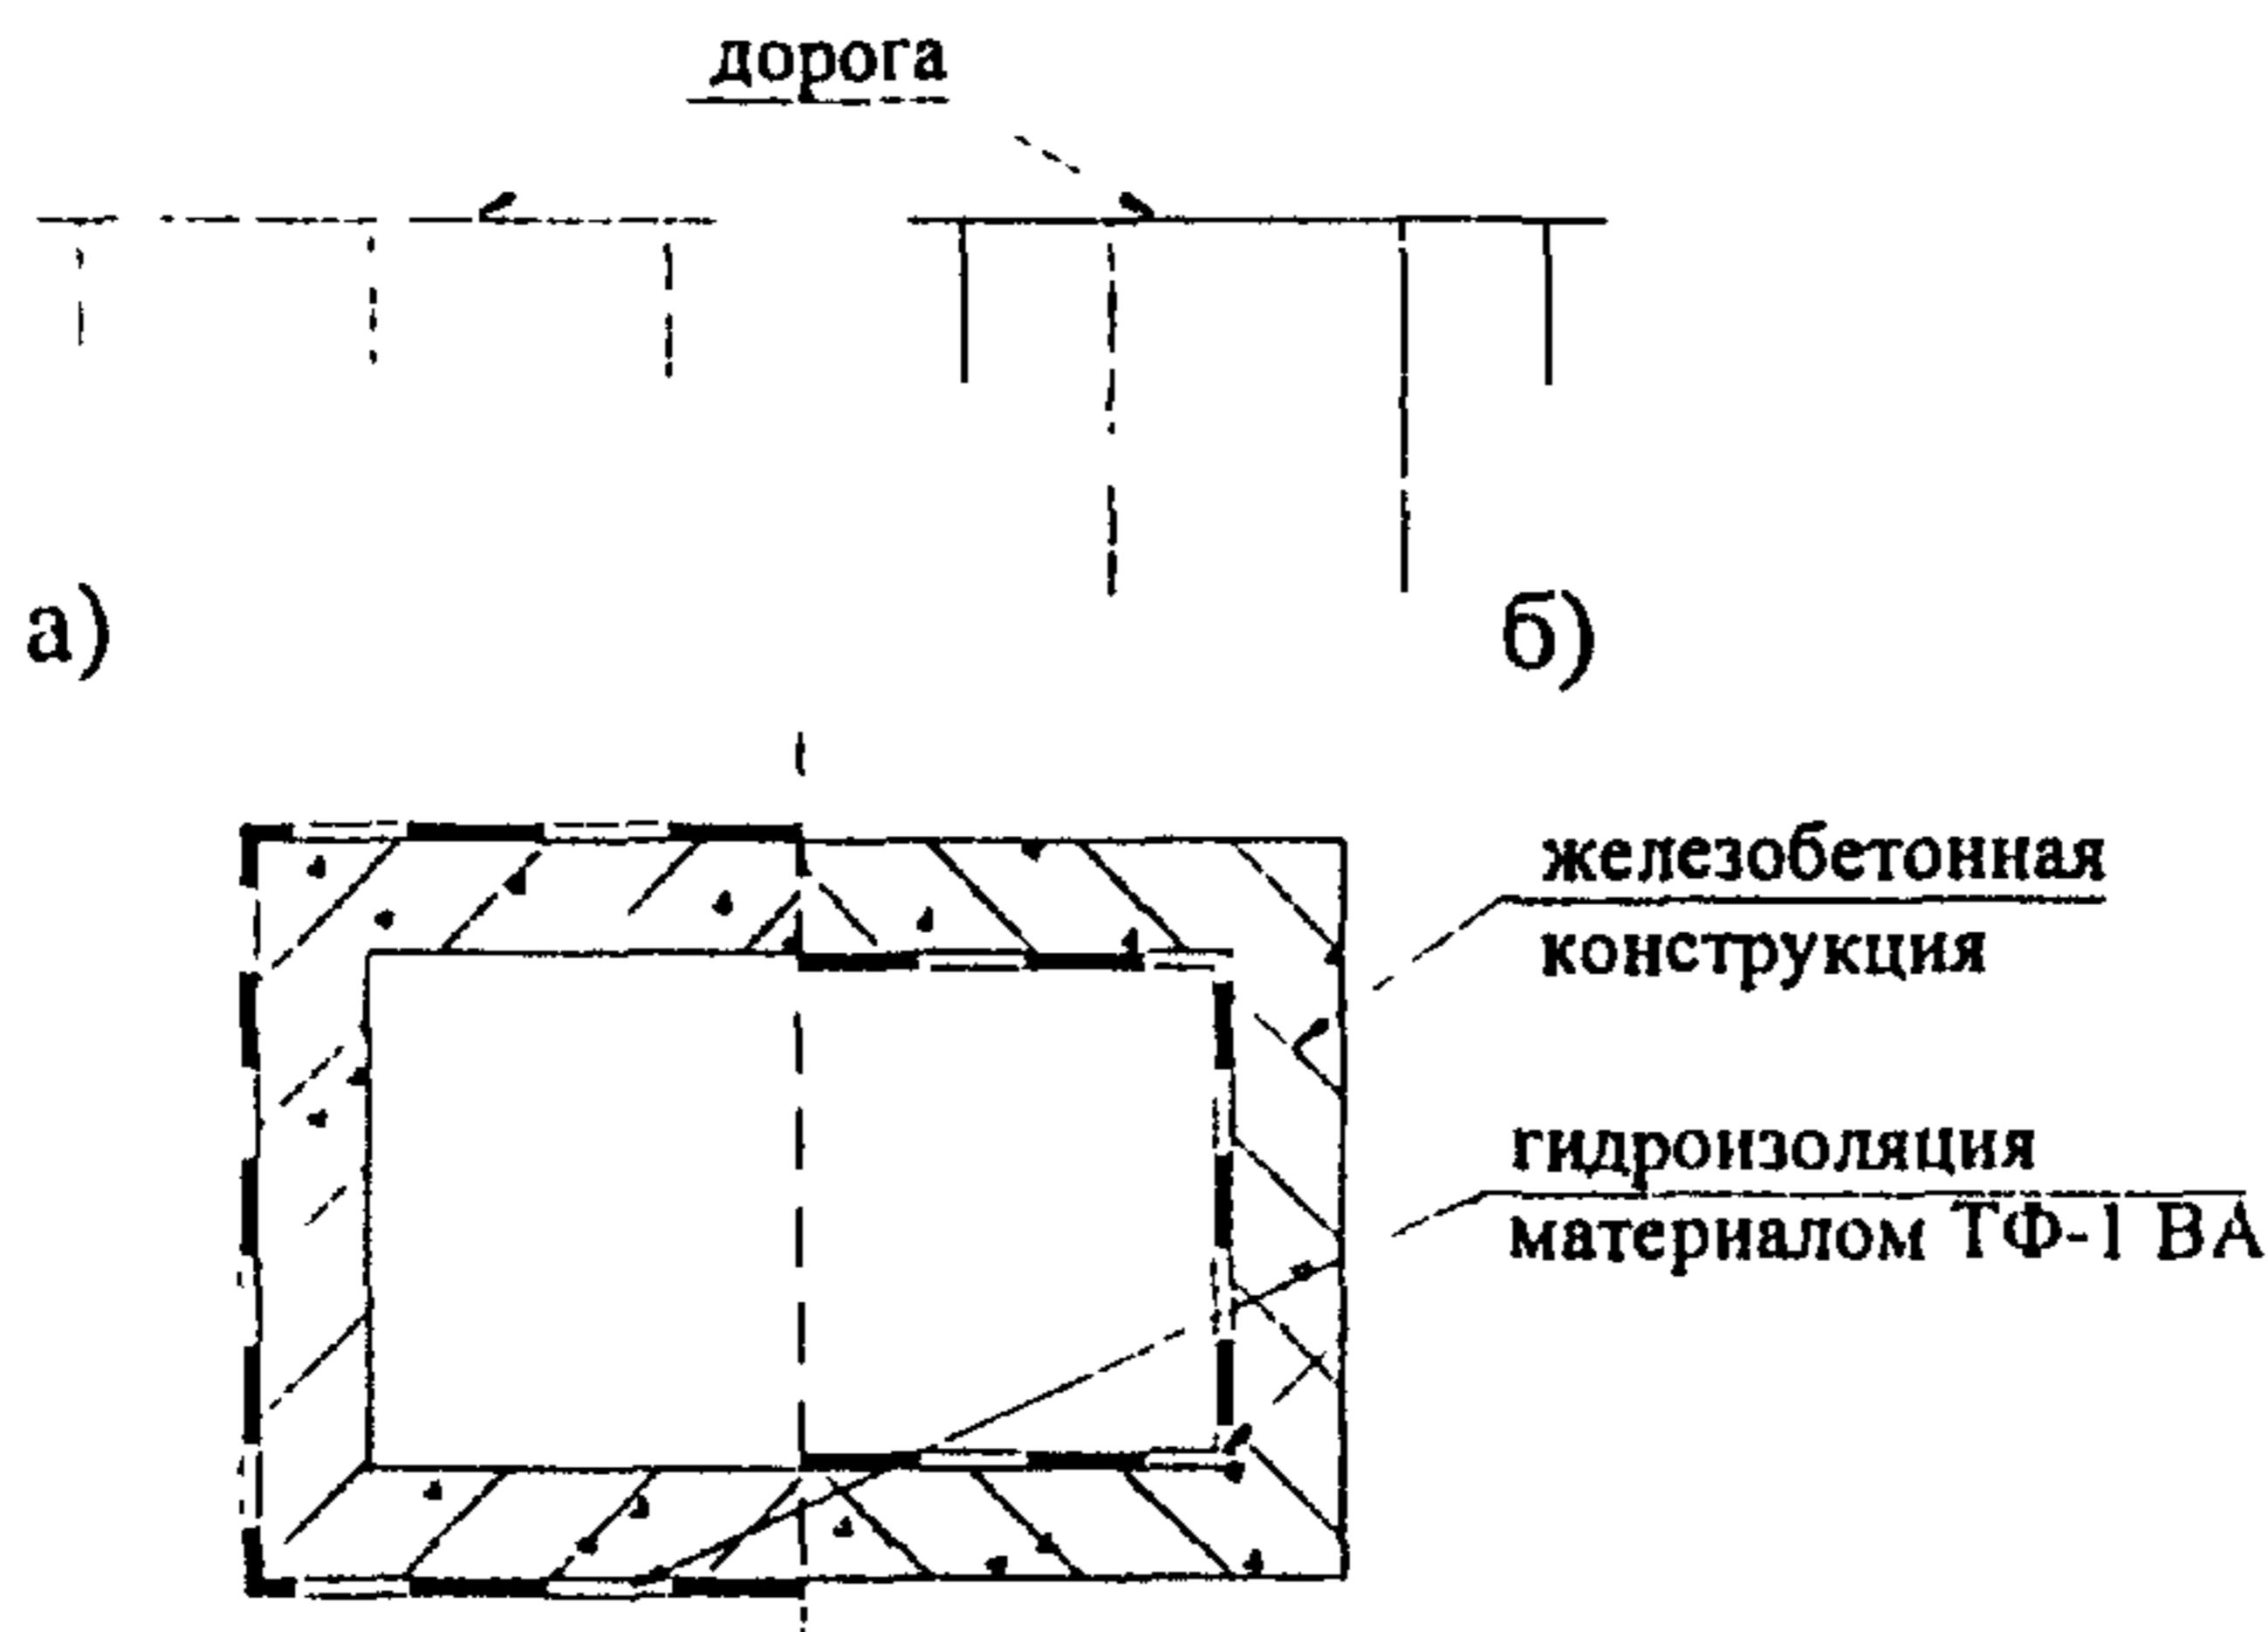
Варианты гидроизоляции водопропускных труб и пешеходных переходов:
